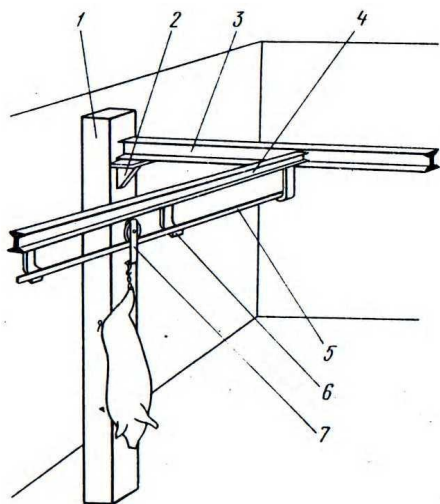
Однорейковий підвісний шлях з листової сталі
